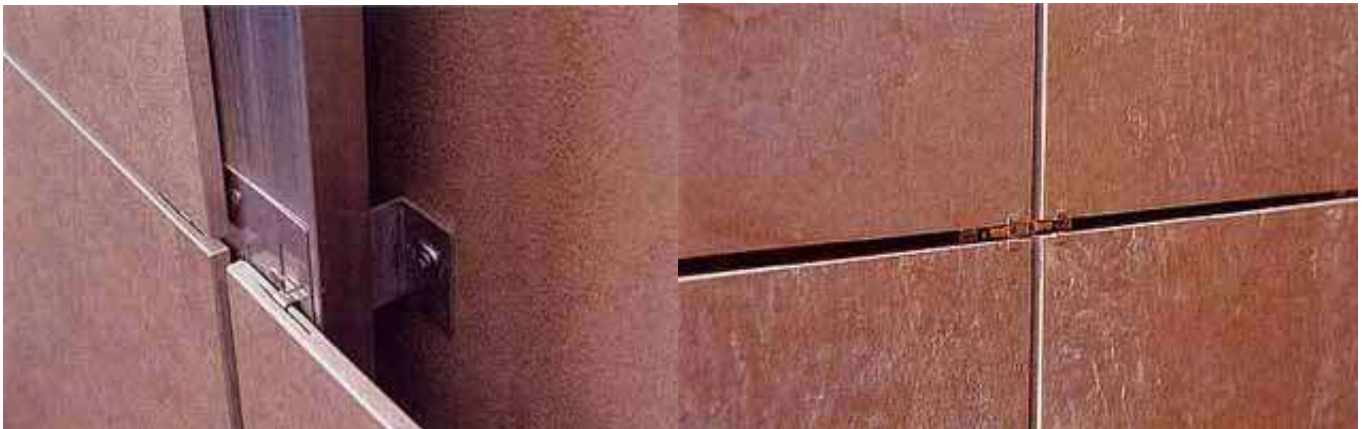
Distintas fases del montaje de la perfilería de una fachada ventilada sistema FV.
